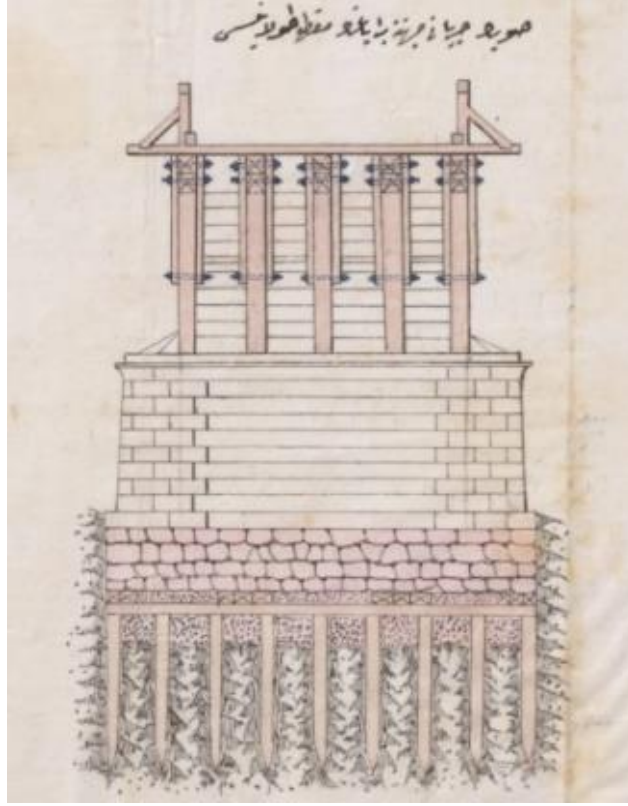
Bir Ayağın Ön ve Yan Görünüşü.
